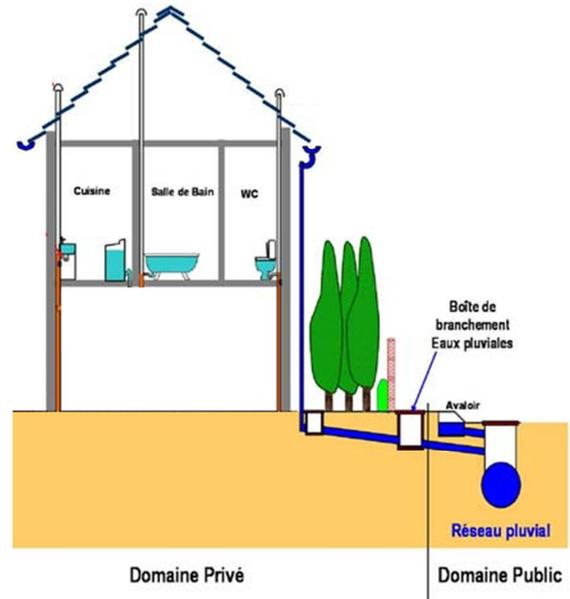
Vue en coupe d'un raccordement individuel au réseau pluvial collectif
